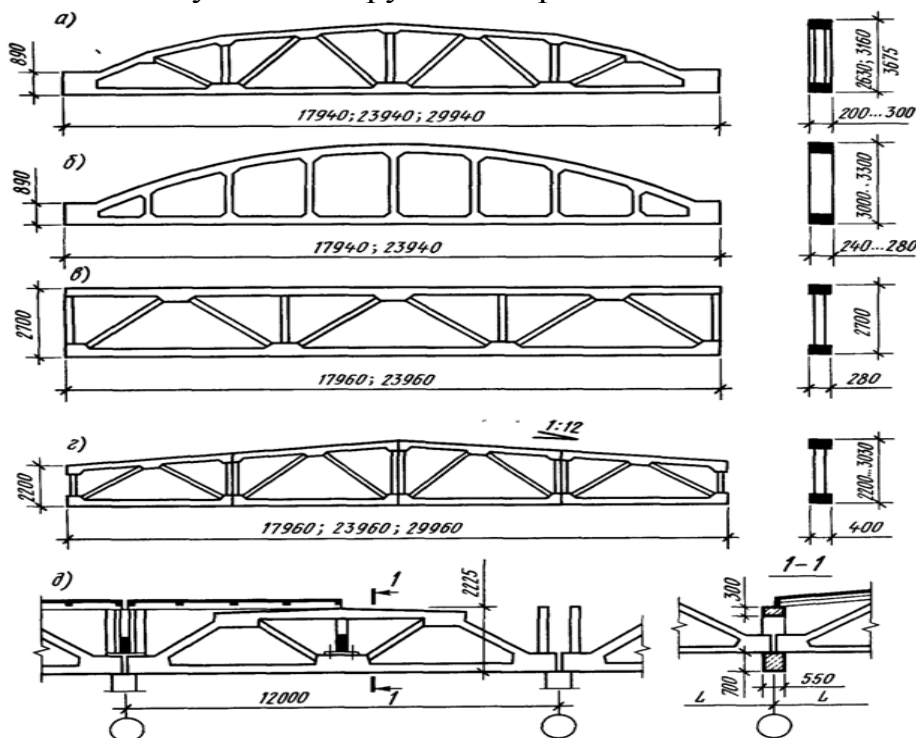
Залізобетонні ферми покриття: а — сегментна, б — аroachна без розкосна, в — з паралельними поясами, г — трапецеїдальна, д — фрагмент розрізу покриття будівлі із застосуванням підкрюквяних ферм.
